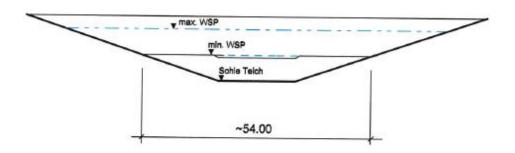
Planskizze des vorhandenen Regenrückhalteteiches
